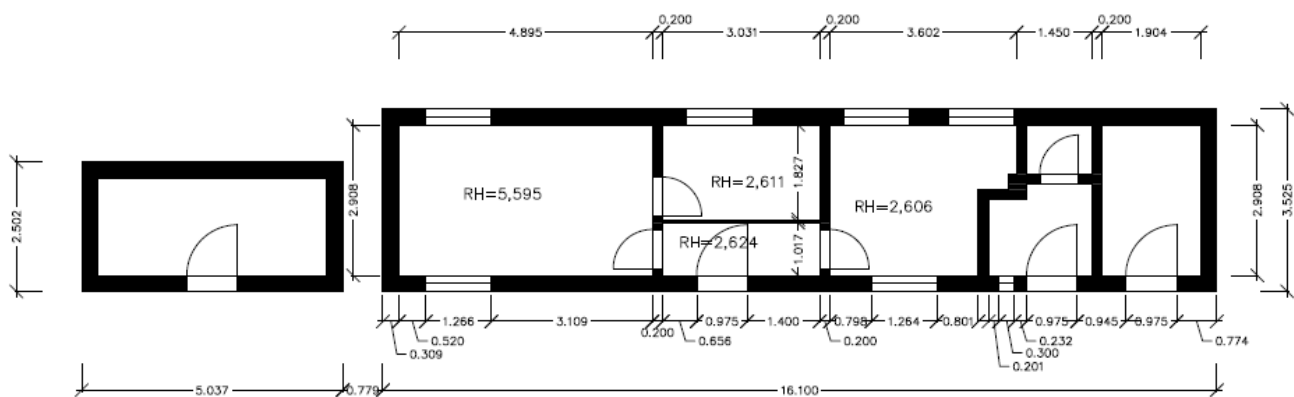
Grundriss Aufenthaltsräume nach Aufmaß vom 07.05.2025
